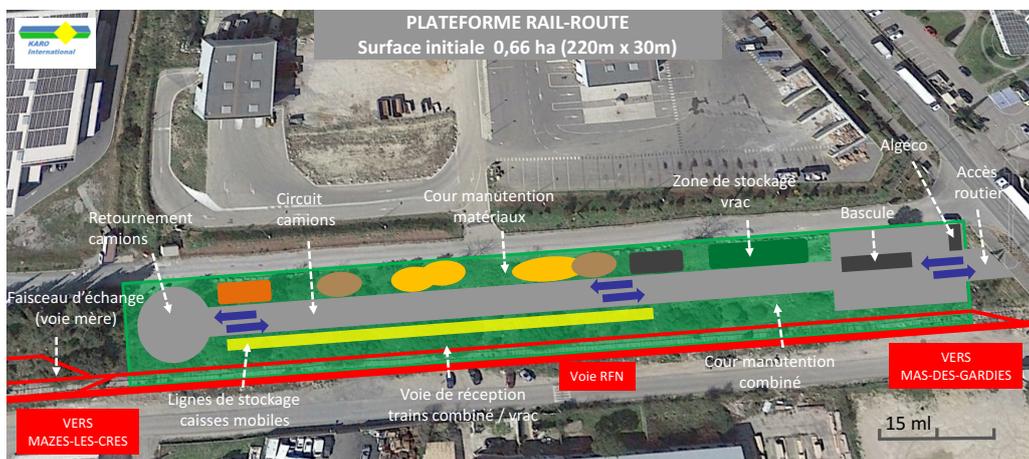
Plan masse Projet de plateforme rail-route du Salaison | Source Karo, 2017
